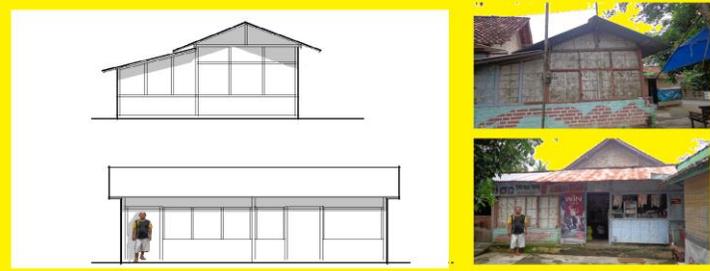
b. Rumah Bapak Baryono, salah satu wujud bangunan dengan ketinggian kolom bangunan 2m
